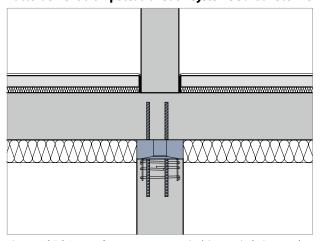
Schöck Sconnex® type P pour poteau intérieurs et isolation sous la dalle
